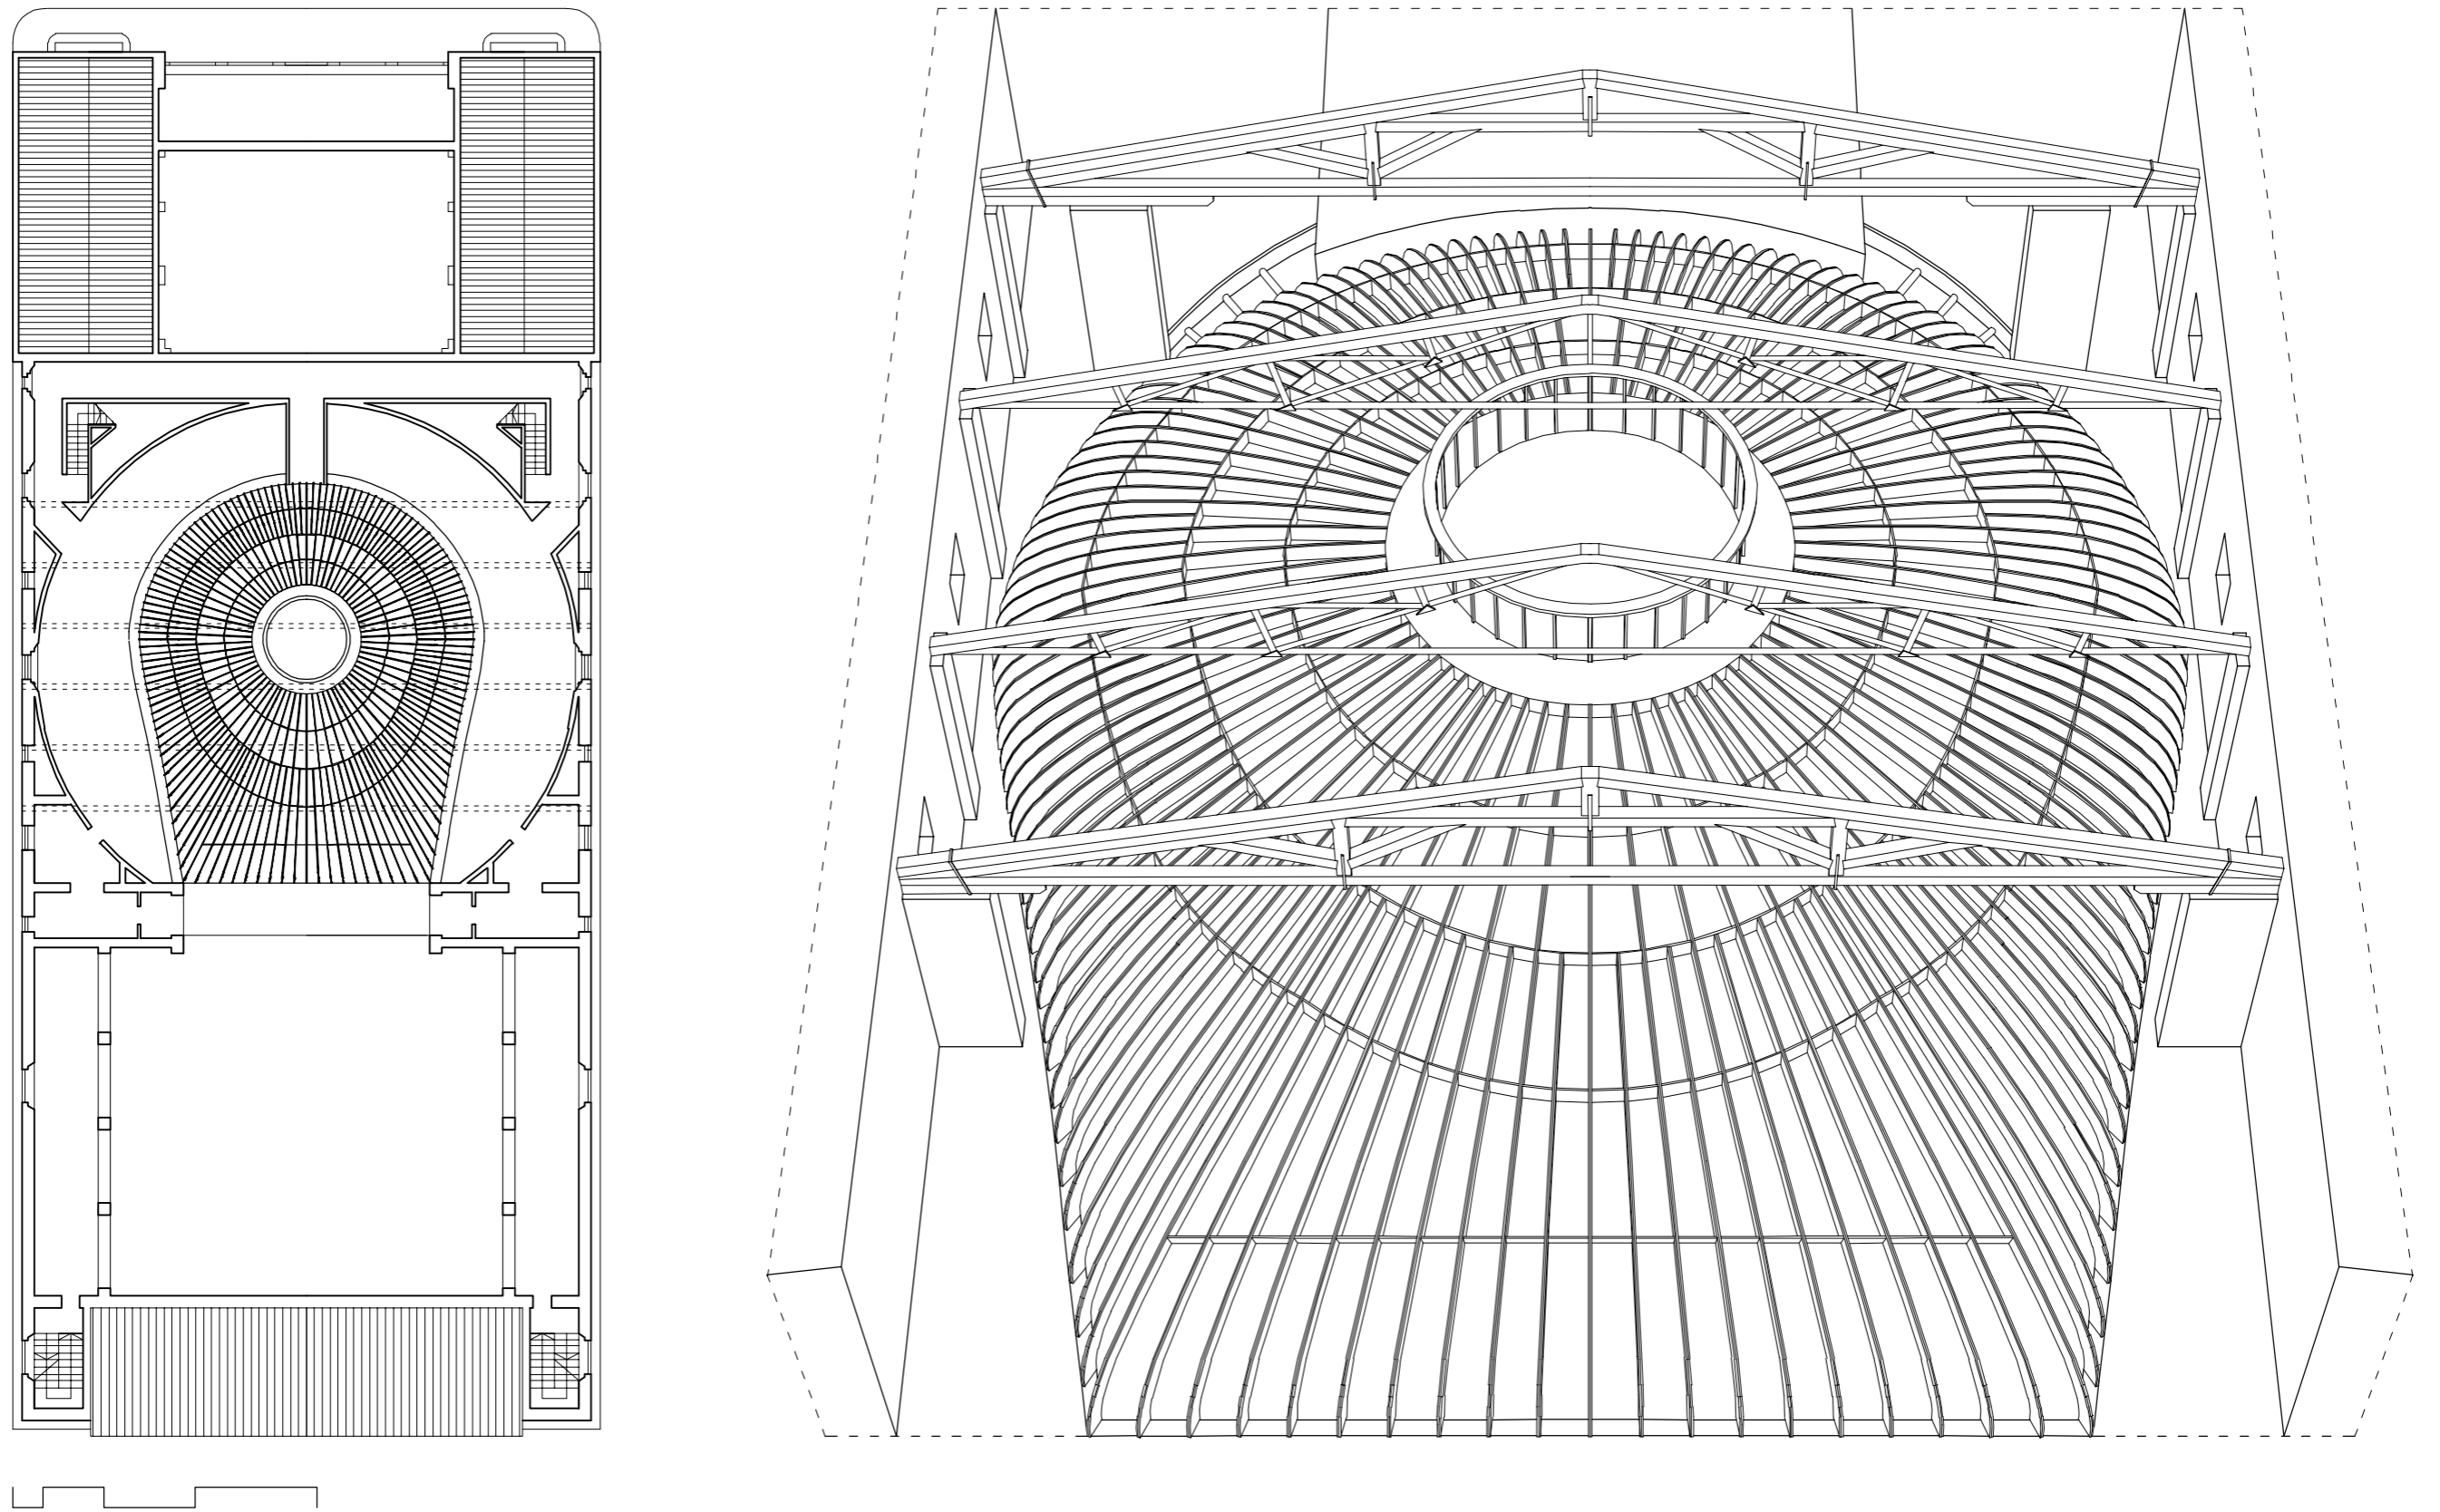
Teatro Nuovo di Mirandola. Pianta del piano sottotetto (ridisegno); rappresentazione prospettica del sistema di copertura della sala.
